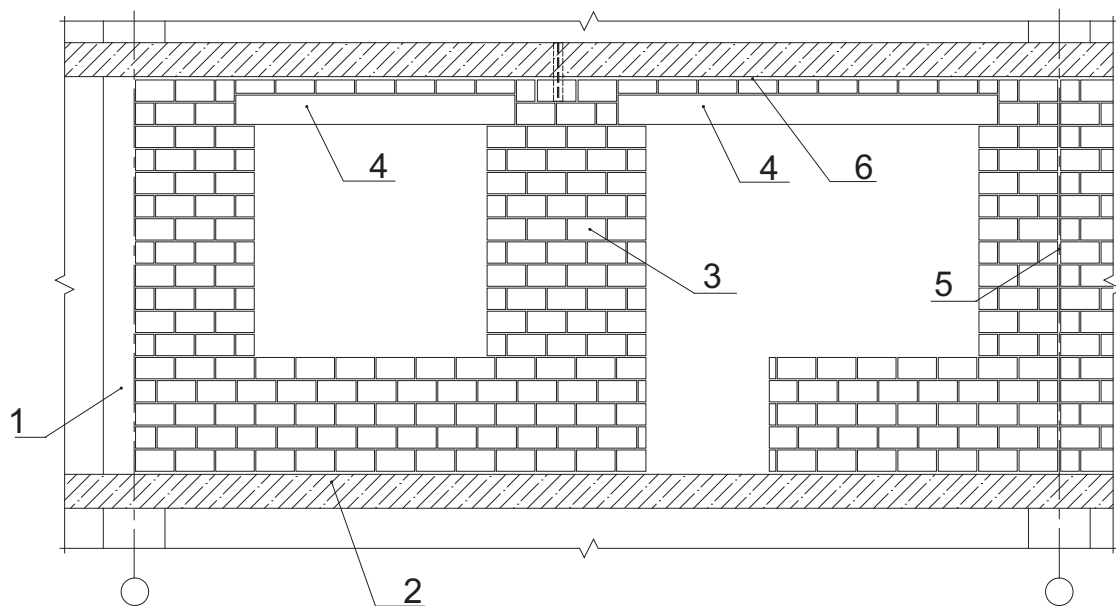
Схема устройства поэтажно опертых наружных стен из мелких ячеистобетонных блоков: 1 – колонна или поперечная несущая стена; 2 – диск перекрытия; 3 – кладка из ячеистобетонных блоков; 4 – армированная перемычка из ячеистого бетона; 5 – вертикальный деформационный шов; 6 – горизонтальный деформационный шов
